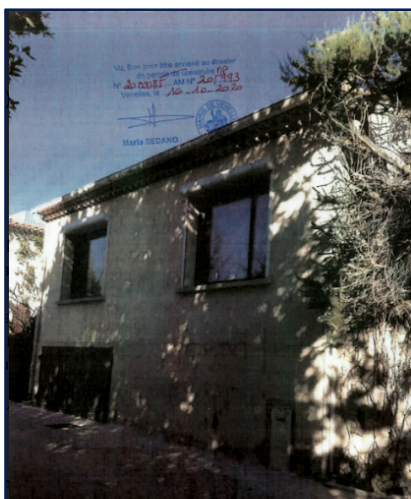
Photographie d'un exemple de ravalement de la façade avant la mise en place de l'outil "Opération façade"
